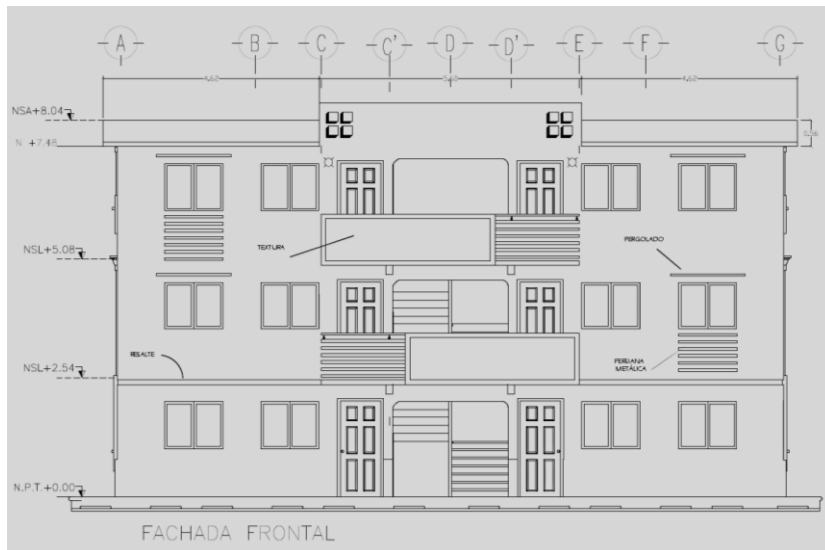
Fachada frontal del conjunto. Fuente: Registro Único de Vivienda
